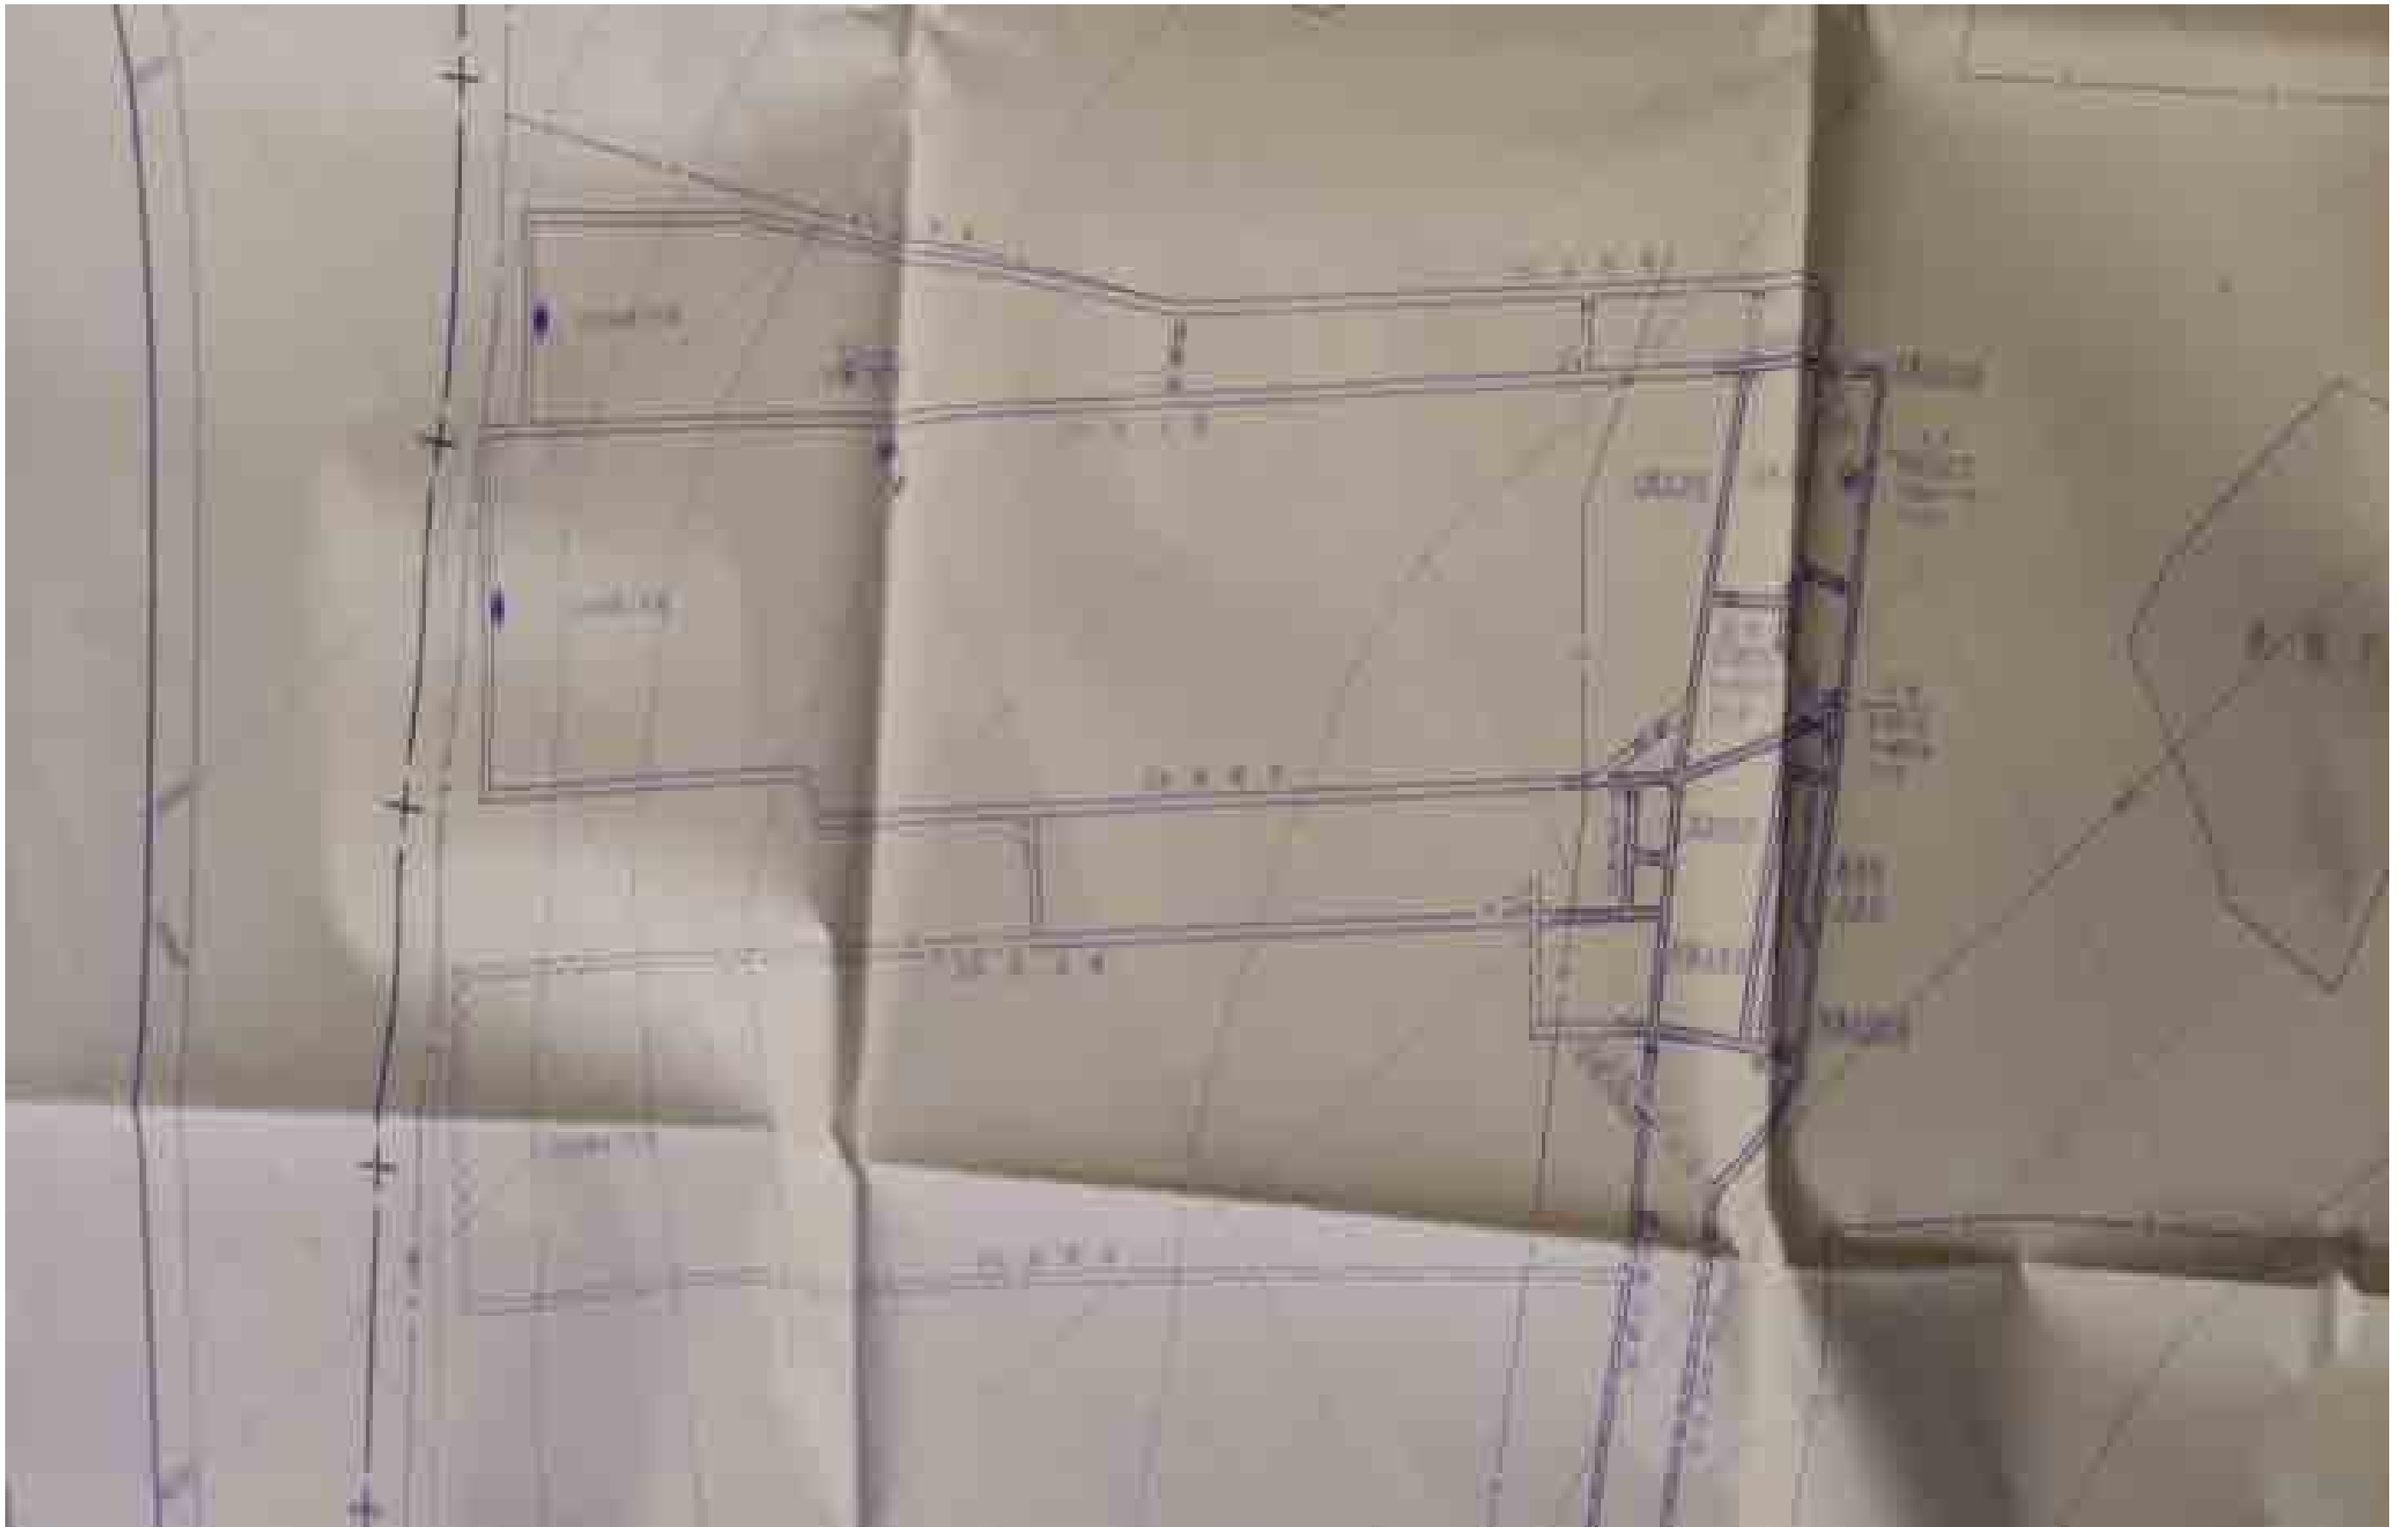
安泽县永兴煤矿 2 号煤巷道布置平面图
